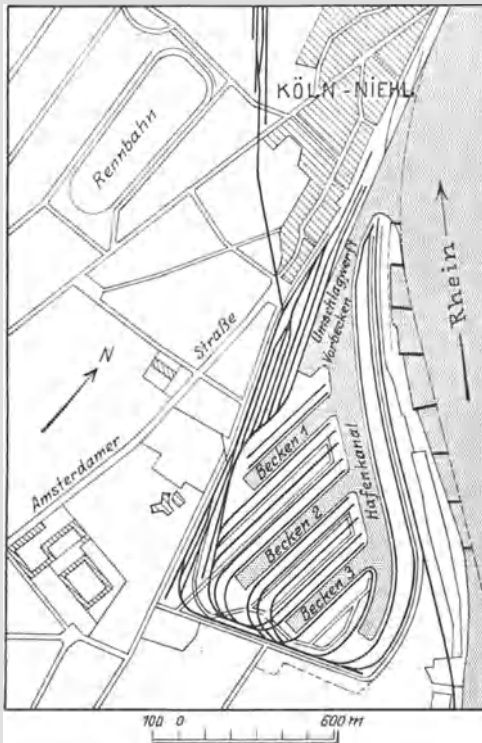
Kölner Hafenanlagen (Handelshafen).
